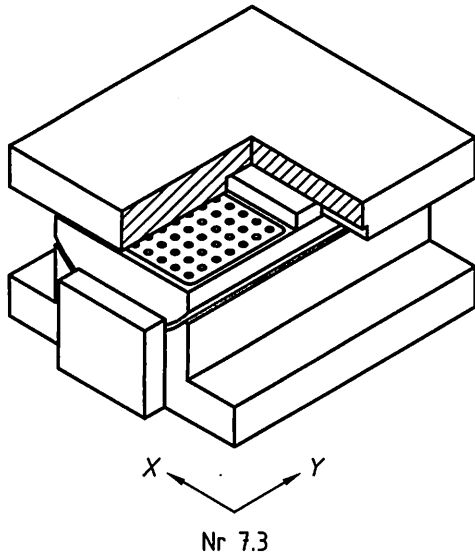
(abgeschlossen) Beispiele der gebräuchlichsten Lager nach Tabelle 1
